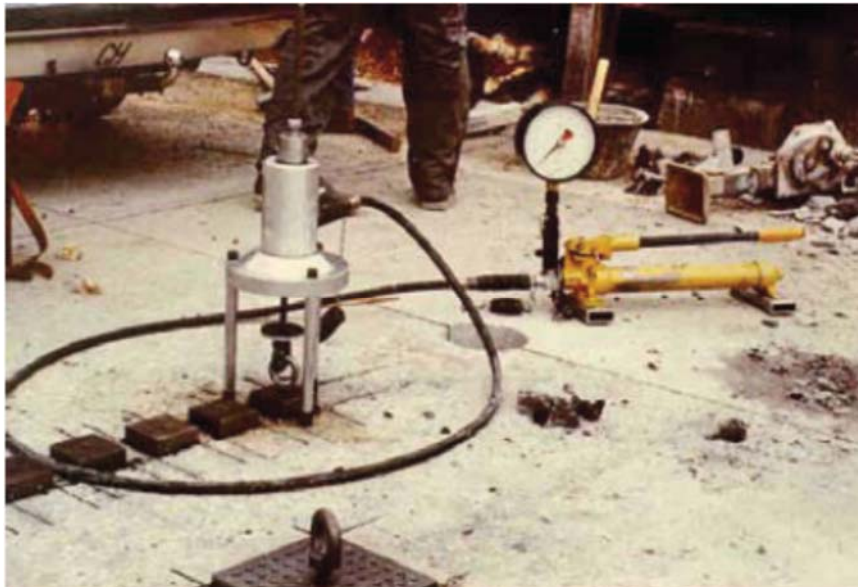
Ilustração do ensaio de tração em campo em placa de concreto (RAAB e PARTL, 1999 apud MUSLICH, 2009)
